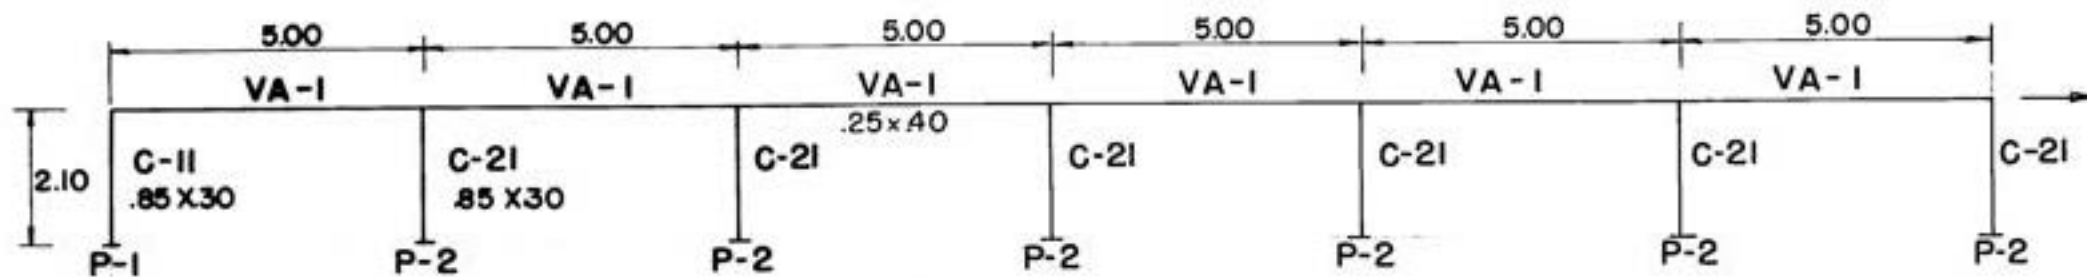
CALCULO DE VIGA VA-I ESQUEMA DE EJES
